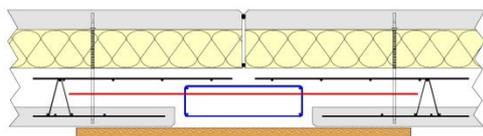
Poteau coulé en place au droit d'un joint vertical
